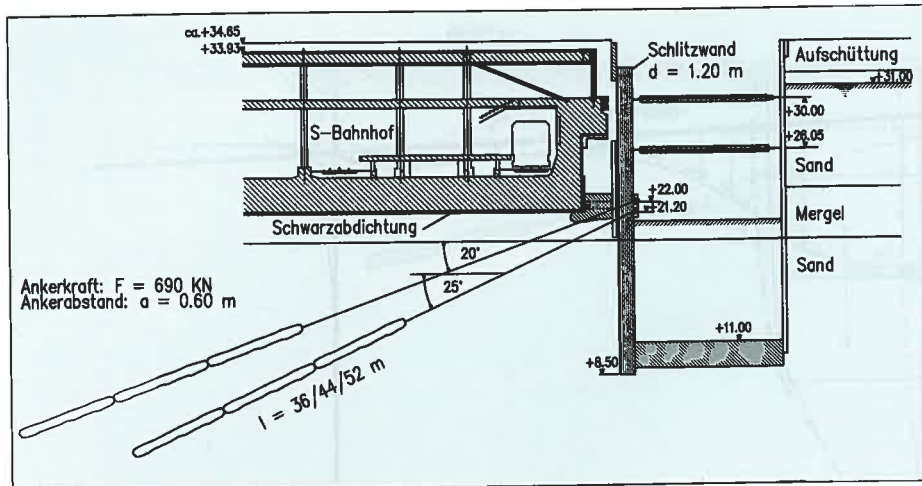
Querschnitt S-Bahnhof und Baugrube Potsdamer Platz
